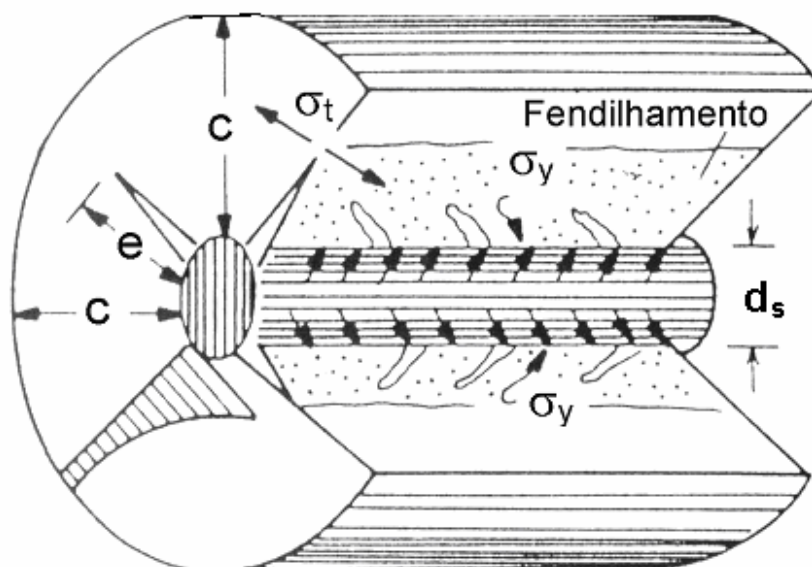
Tensões de fendilhamento após as fissurações transversal e longitudinal (TEPFERS, 1979).
